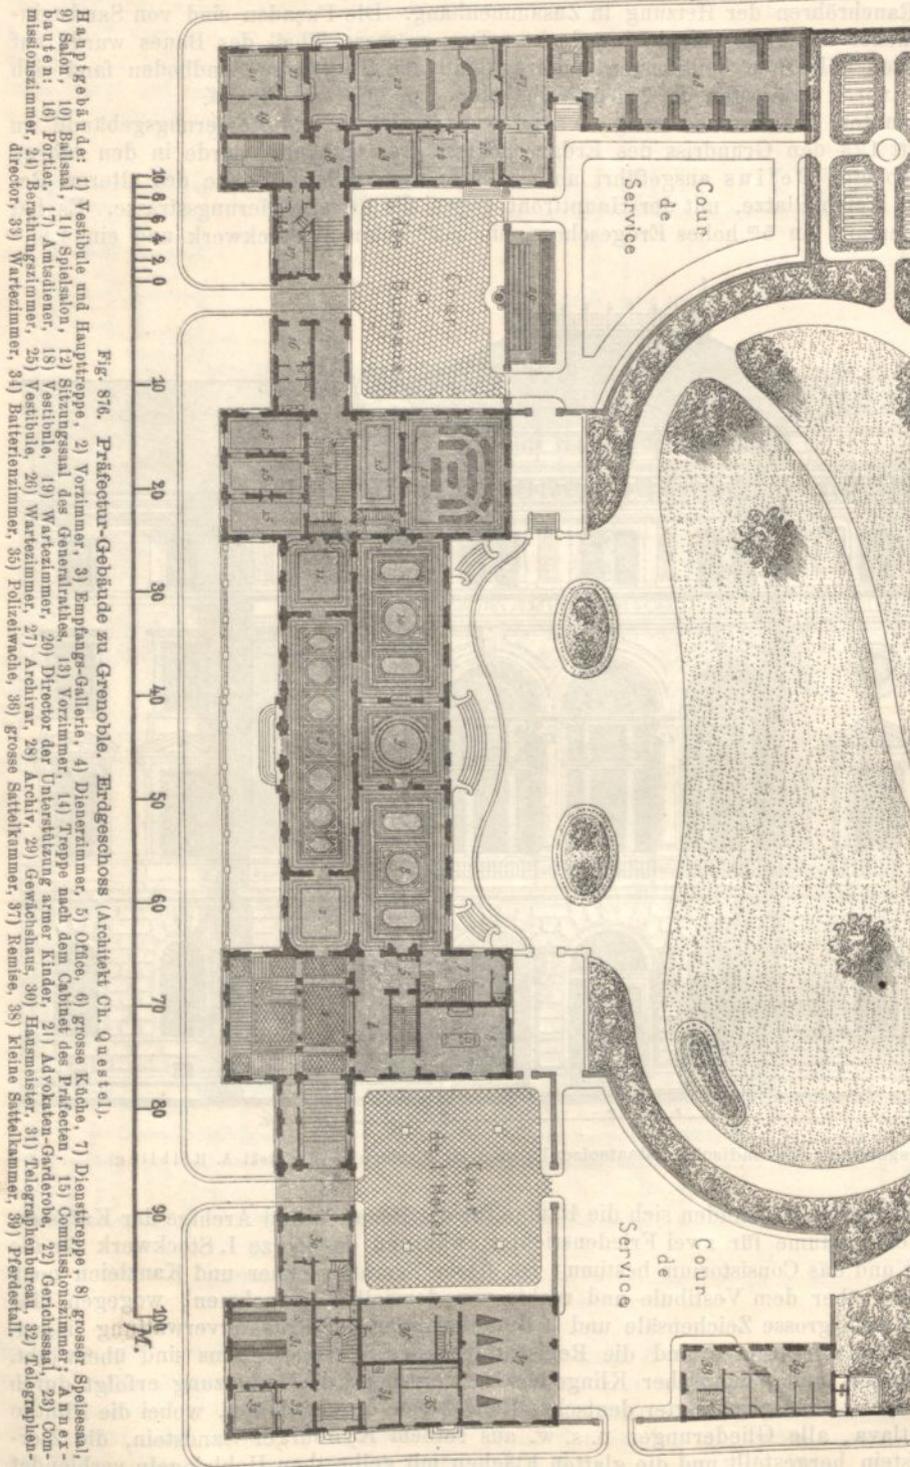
Präfecur-Gebäude zu Grenoble. Erdgeschoss (Architekt Ch. Questel).
